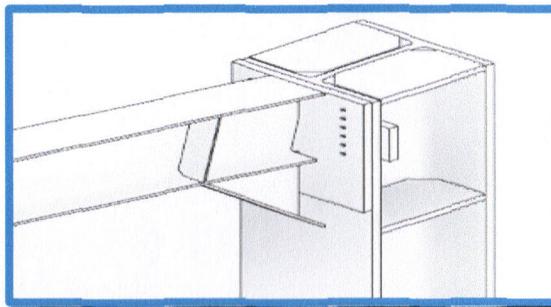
ASSEMBLAGE POTEAU POUTRE.
